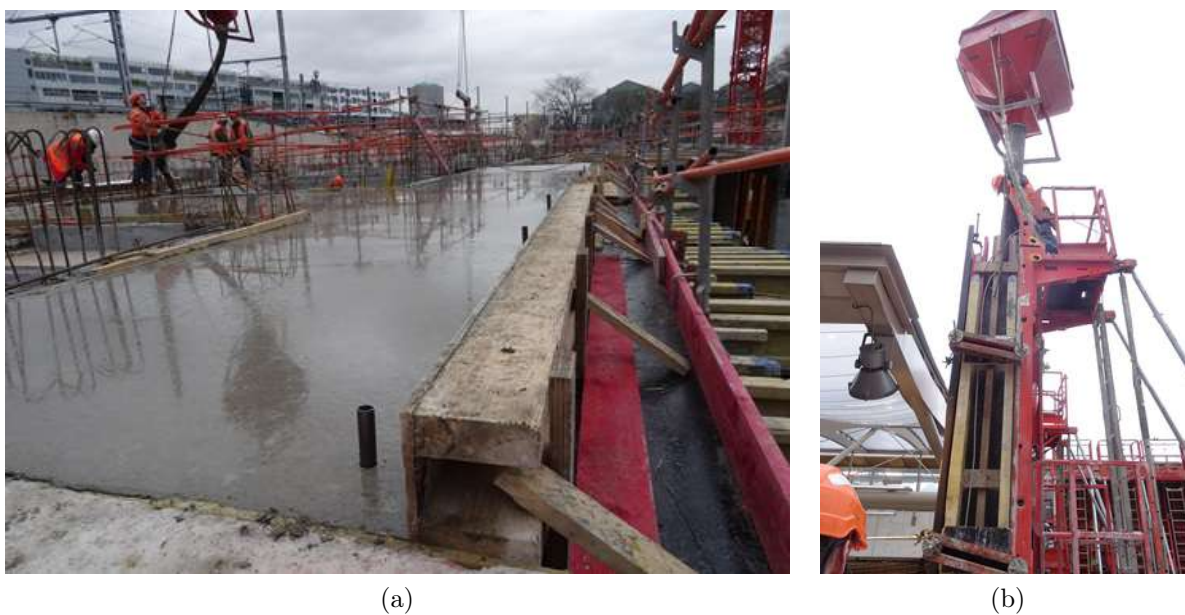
(a) Dalles coulées sur place (b) Poteau coulé sur place
